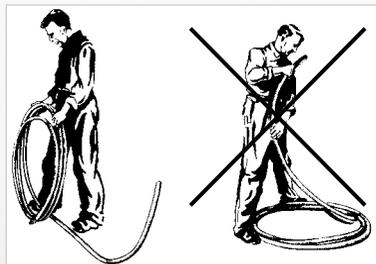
Mise en place correcte (à gauche) et incorrecte (à droite) d'une conduite flexible
